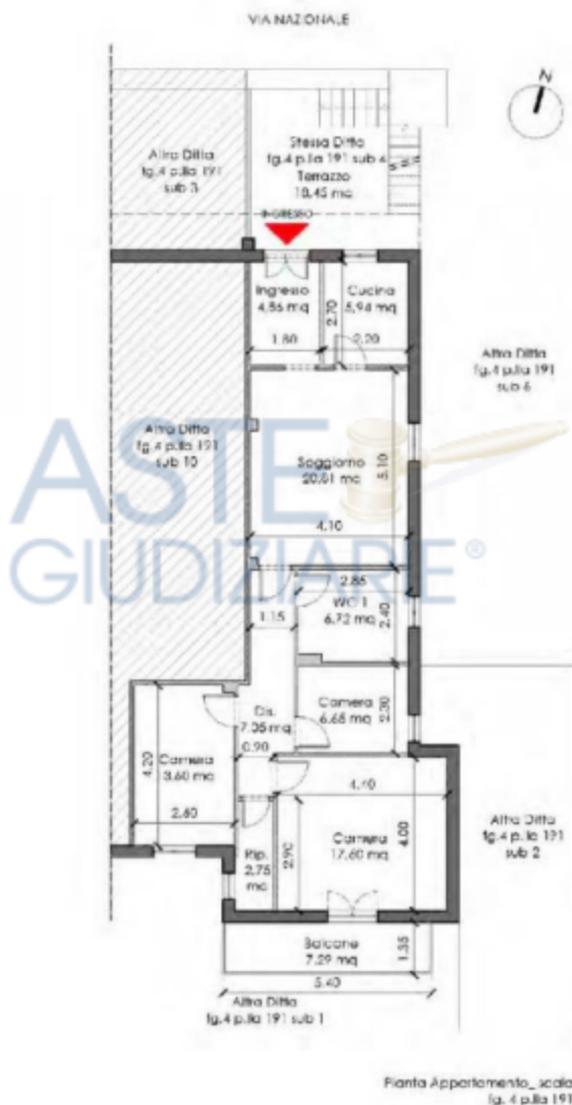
Rilievo Stato di fatto \_ Pianta piano primo (Allegato 60)
